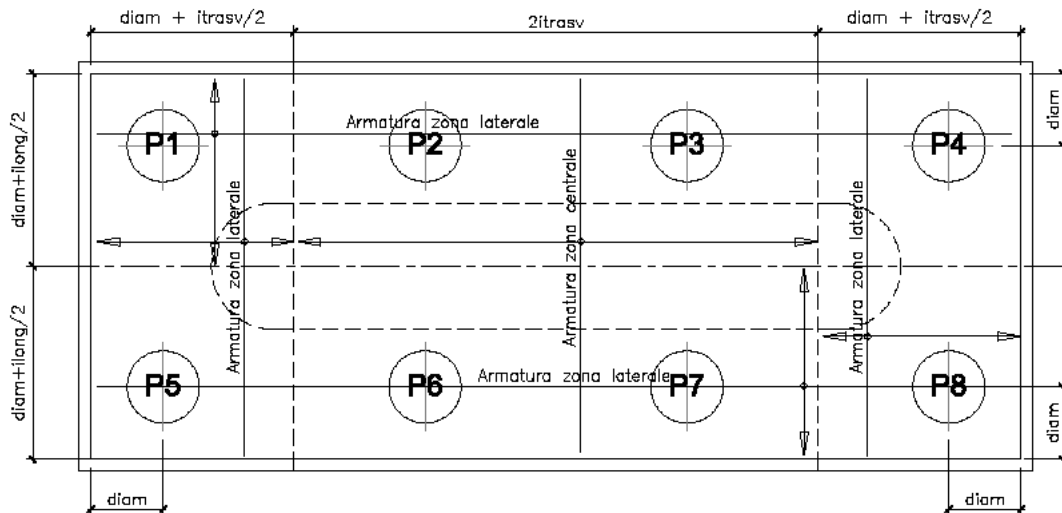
Plinto di fondazione – Armatura longitudinale inferiore e superiore
